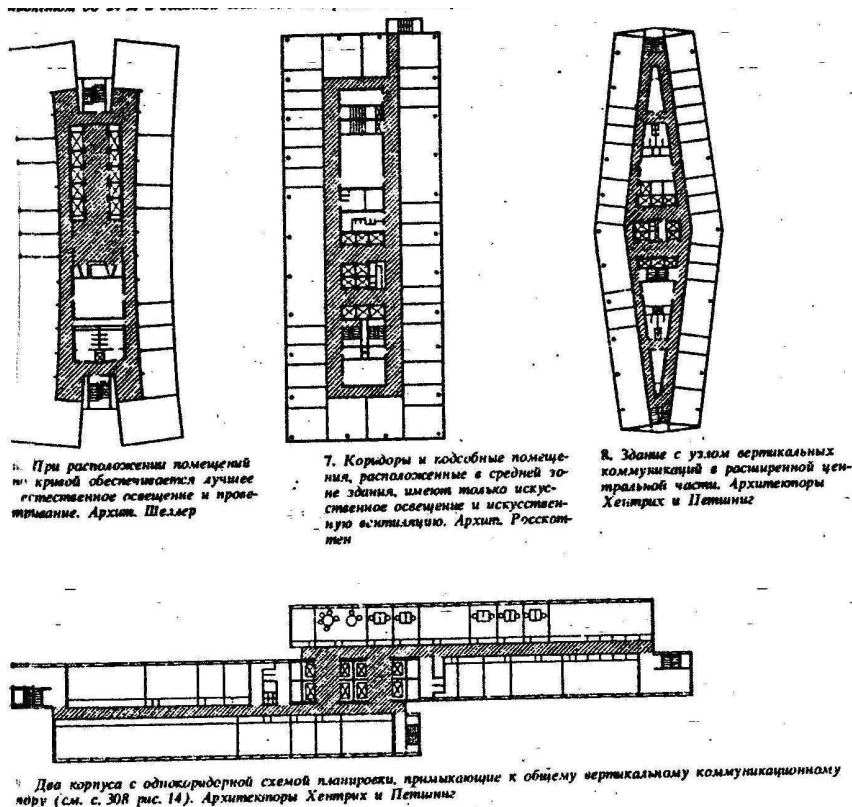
Висотні громадські будівлі (Э. Нойферт. Строительное проектирование. - М.: Стройиздат, 1991. - 392 с.)
